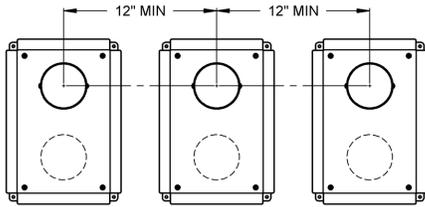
Dégagements minimaux requis entre plusieurs SMAI (installation à la verticale)
